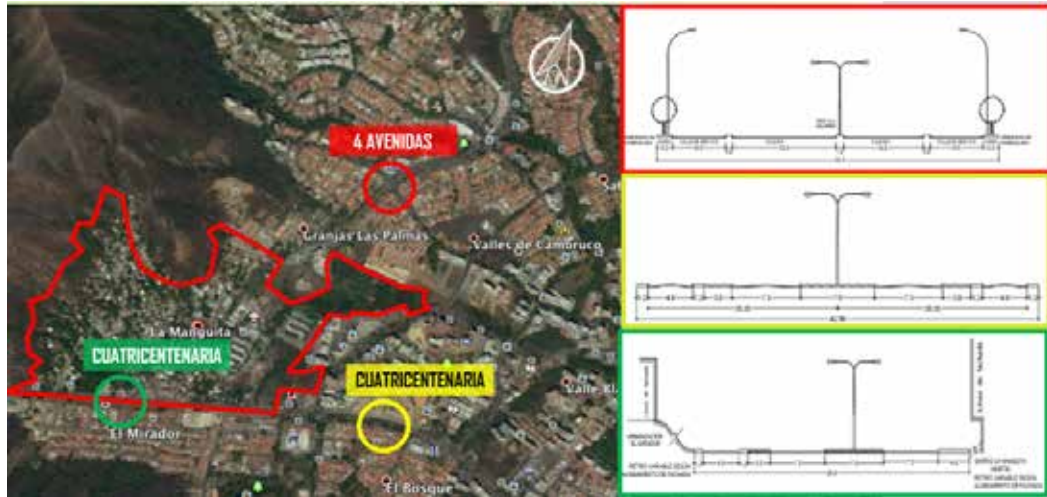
Perfiles Viales Existentes, La Manguita, Parroquia San José, Estado Carabobo, Soto y otros, (2018).
